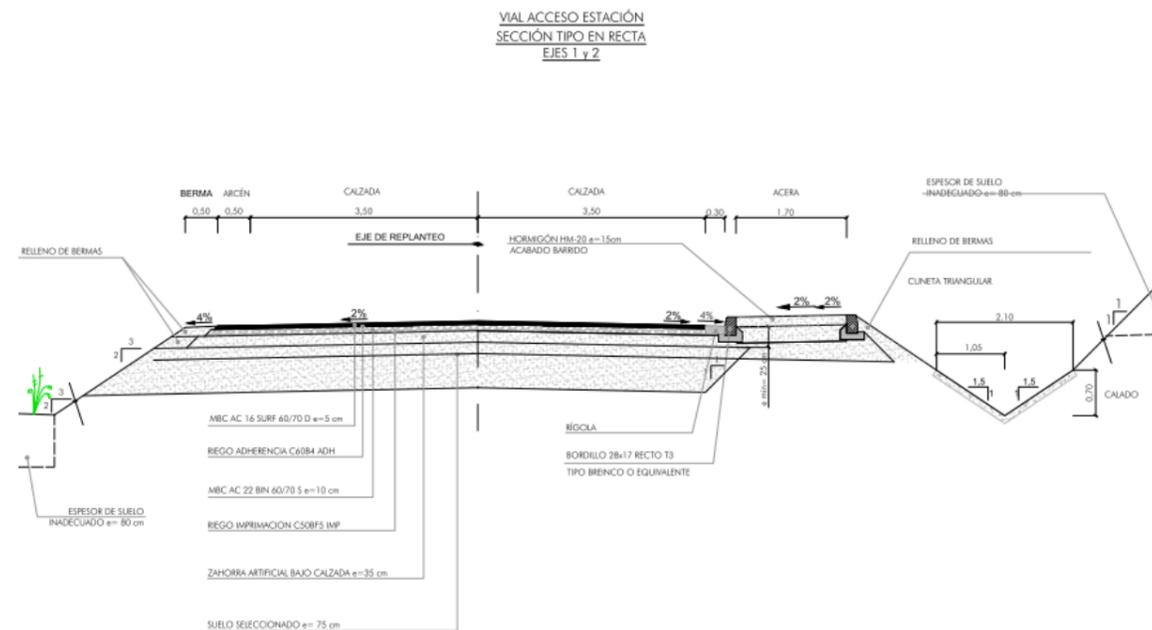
SECCIÓN TIPO VIAL DE ACCESO A ESTACIÓN. FUENTE PROYECTO CONSTRUCTIVO: “NUEVA ESTACIÓN DE ALTA VELOCIDAD DE ELCHE”
